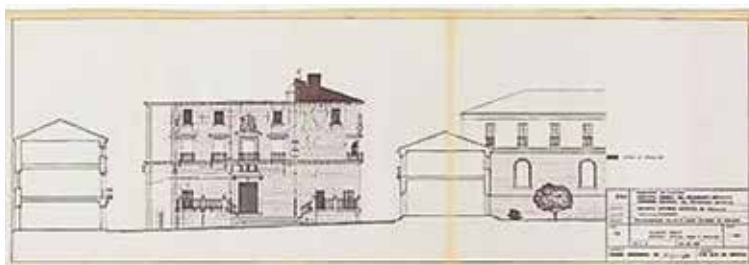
Plano de alzado norte, lo sombreado es zona para demoler, del Teatro Gabriel y Galán de Trujillo (HERNÁNDEZ GIL, D., 1980).
